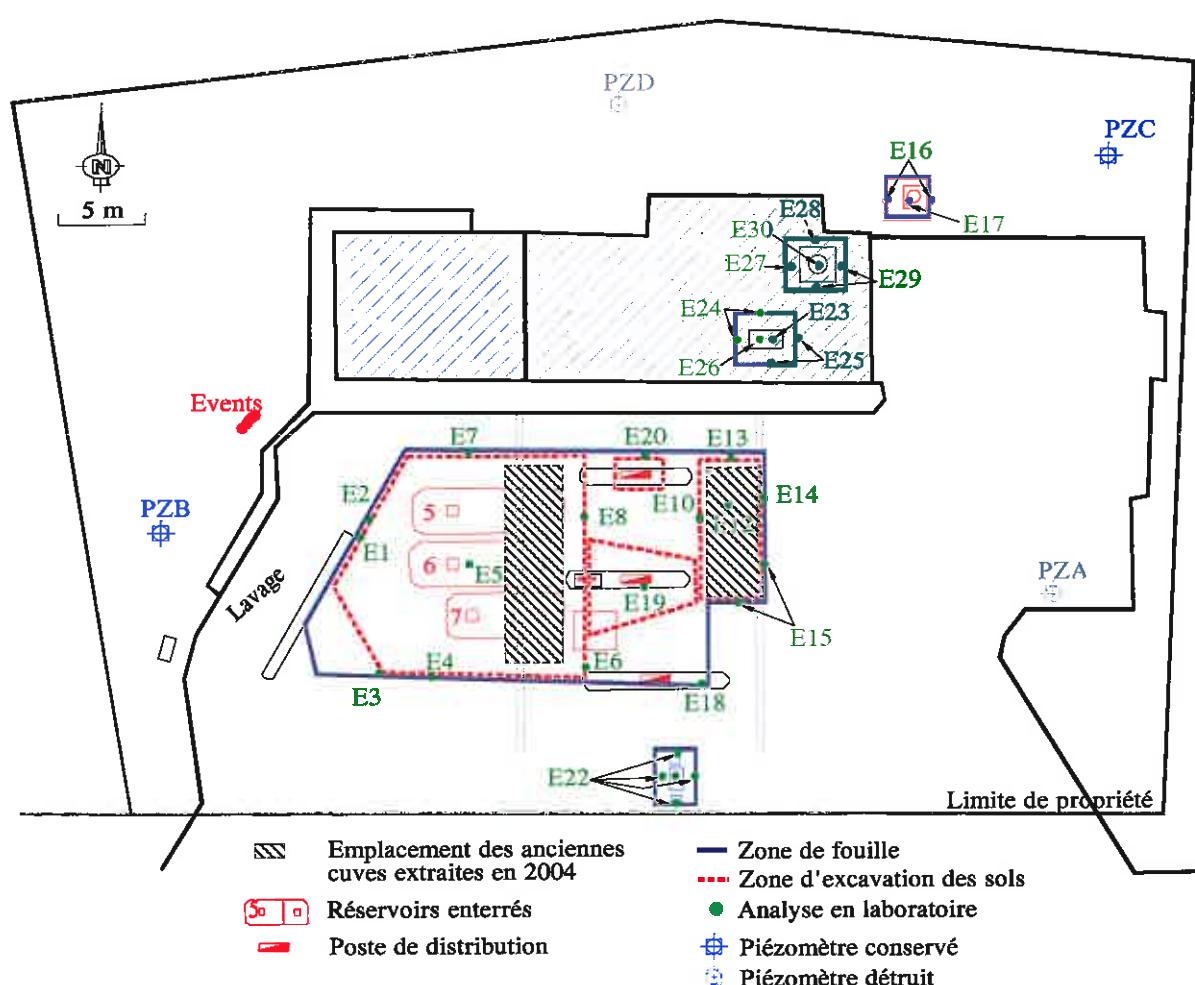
Travaux de démantèlement - plan des fouilles et d'échantillonnage des sols laissés en place.
